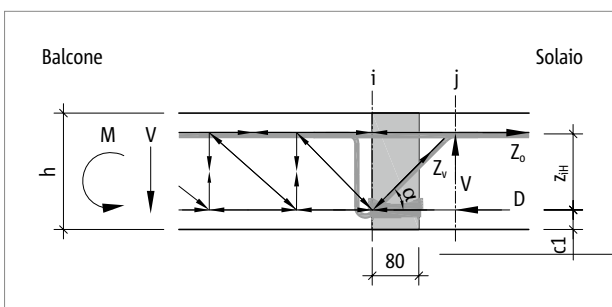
Modello a graticcio Schöck Isokorb® T tipo KL, braccio di leva interno z_{iH}
